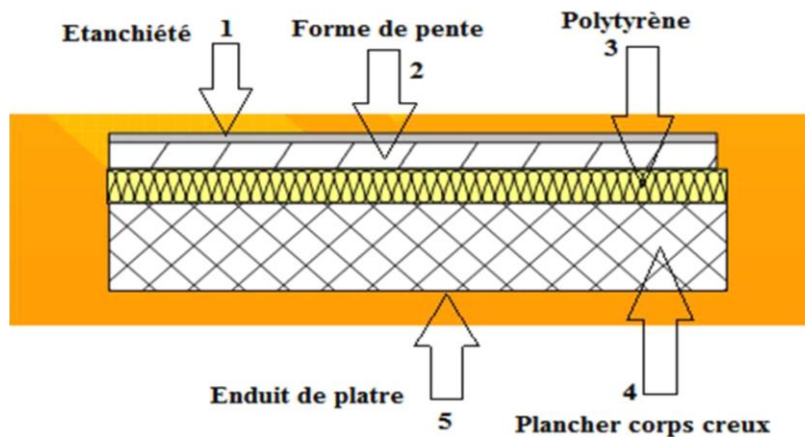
Composition du plancher haut de la cellule d'essai (Gacem, 2013)
